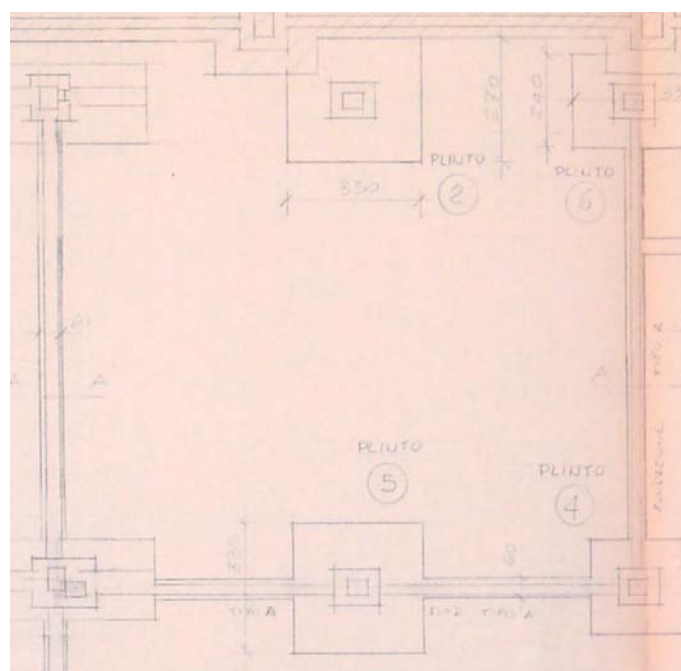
Particolare di A.1990.cap.us.T06 - Pianta delle fondazioni - Fondazioni porzione m
